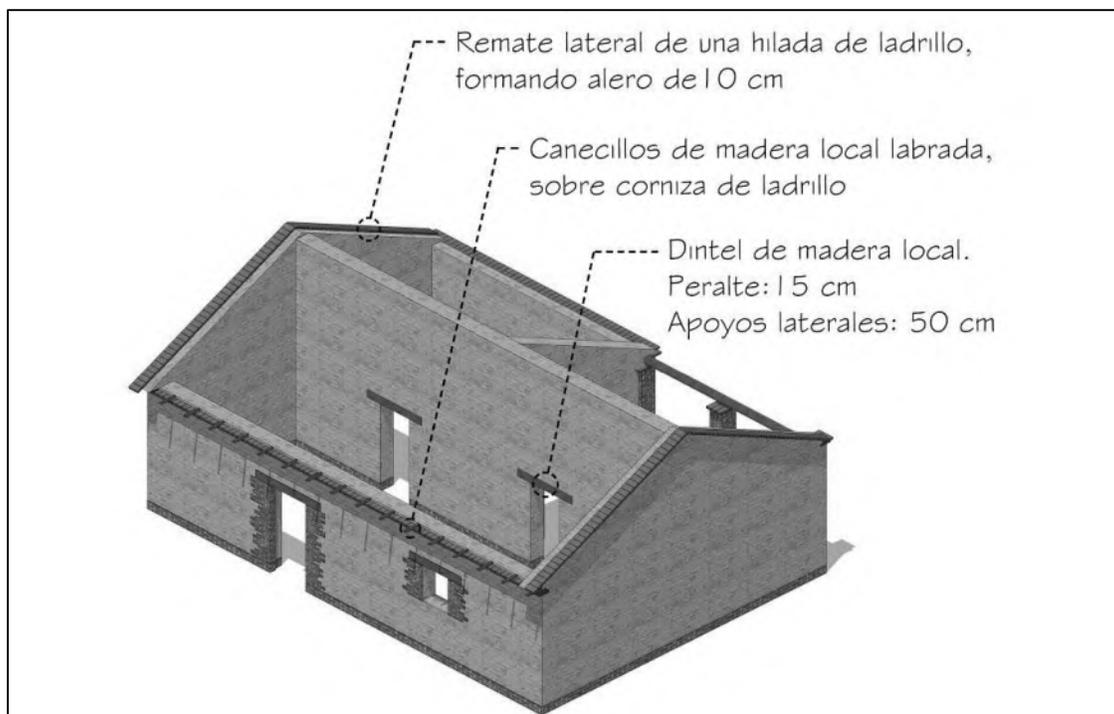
Proceso constructivo de la casa de adobe. Remate de muros, canecillos y dinteles. Fuente: elaboración propia.
